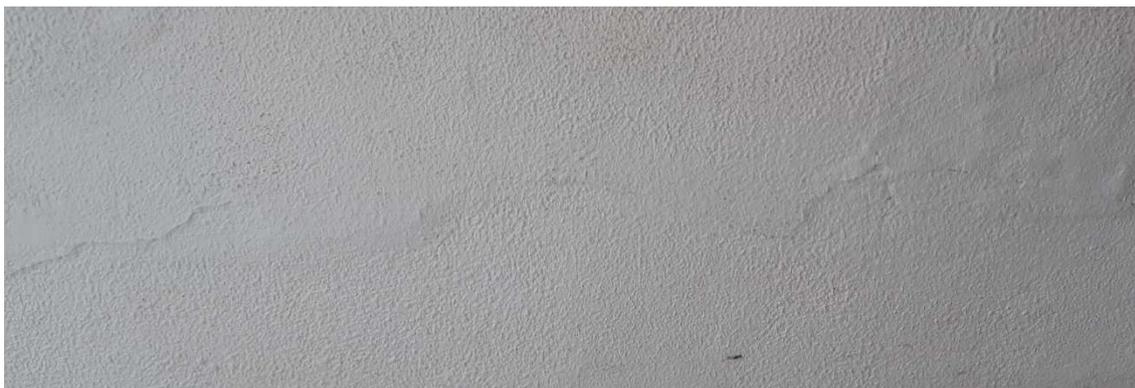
Fissuração horizontal interior piso 3 e 2;
